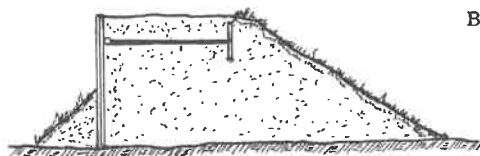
Schallwälle als Fangedamm-Konstruktionen:
